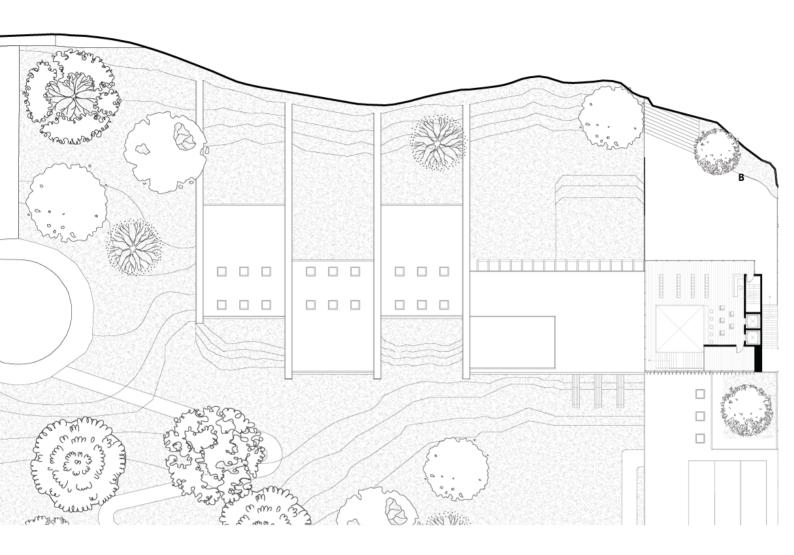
Planta Nivel +10.50m. Elaboración Propia
